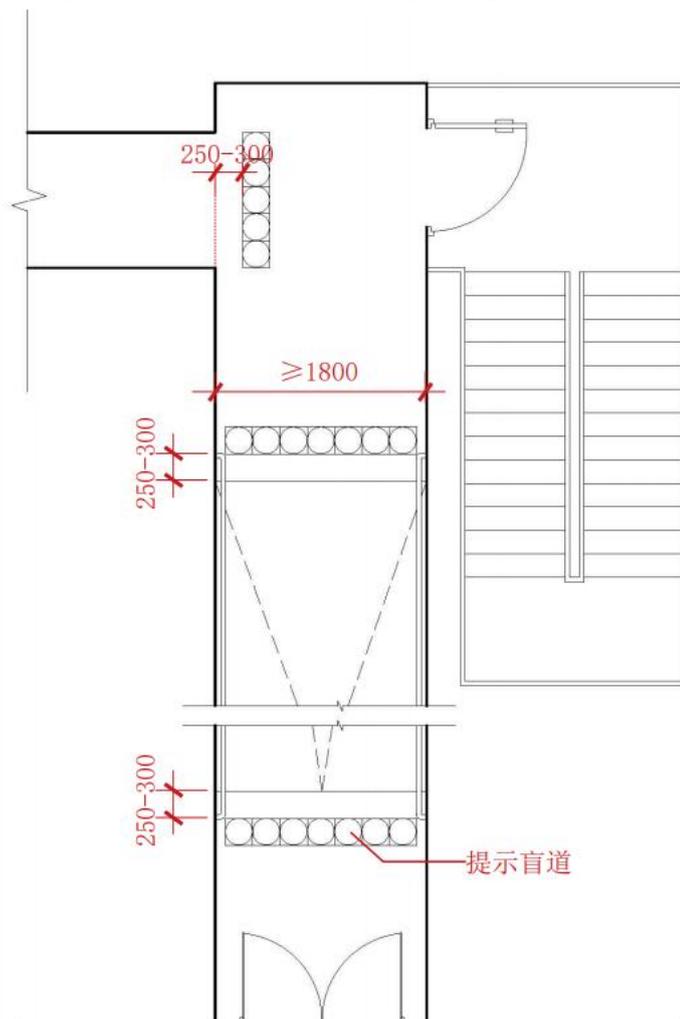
登机桥内提示盲道示意图（单位：mm）
